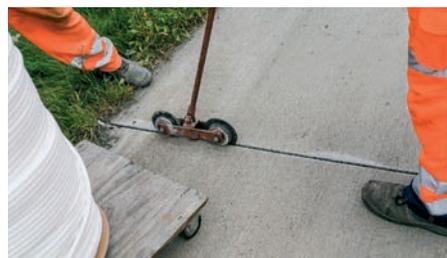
Einbau eines Unterfüllstoffes in die Fuge einer Verkehrsfläche aus Beton
